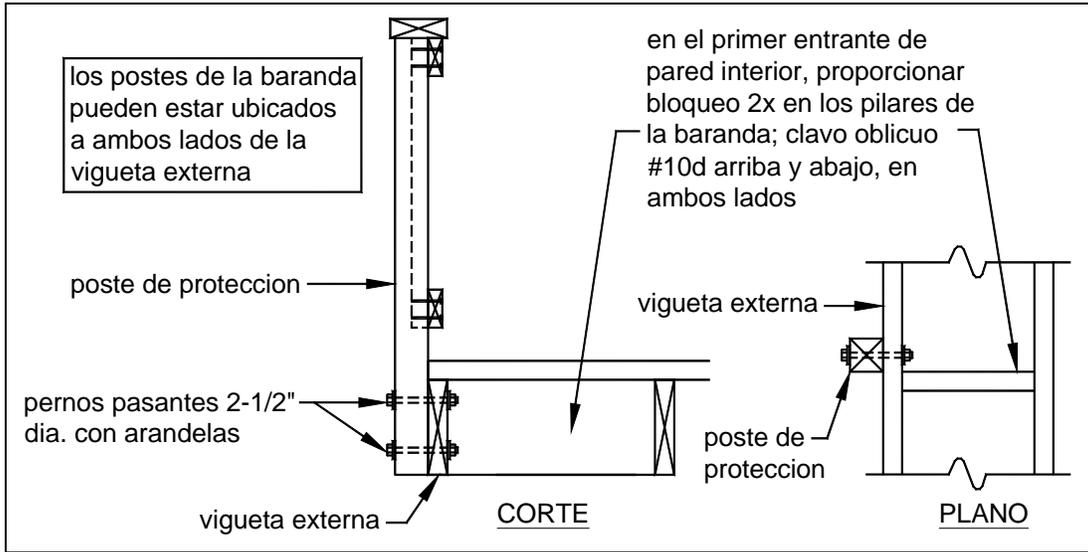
DETALLE SOBRE LOS PILARES DE LA BARANDA CON LA VIGUETA EXTERIOR
